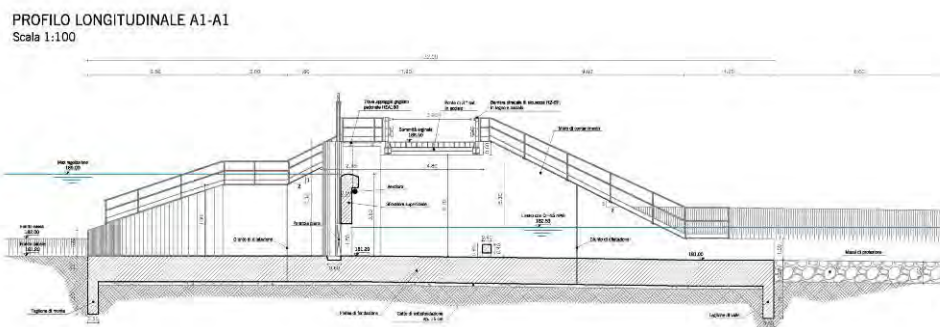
Opera di Restituzione –Profilo longitudinale
